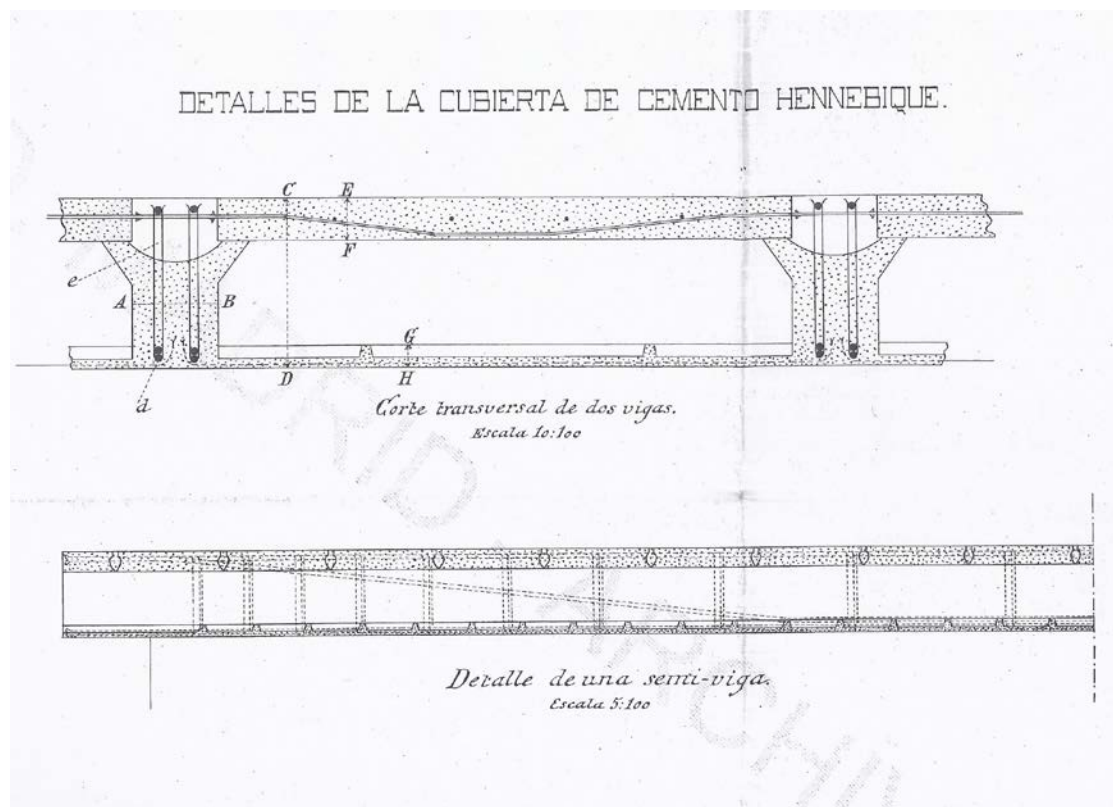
Detalle constructivo de la Cubierta de Cemento Hennebique del Taller de Precisión de Artillería de Madrid. Archivo de Villa de Madrid
